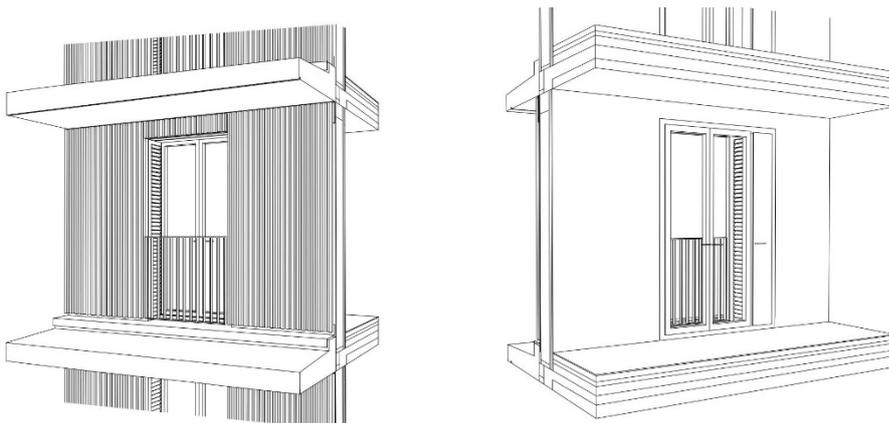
Beton-Krempe und Außenwand © Peter W. Schmidt Architekten
